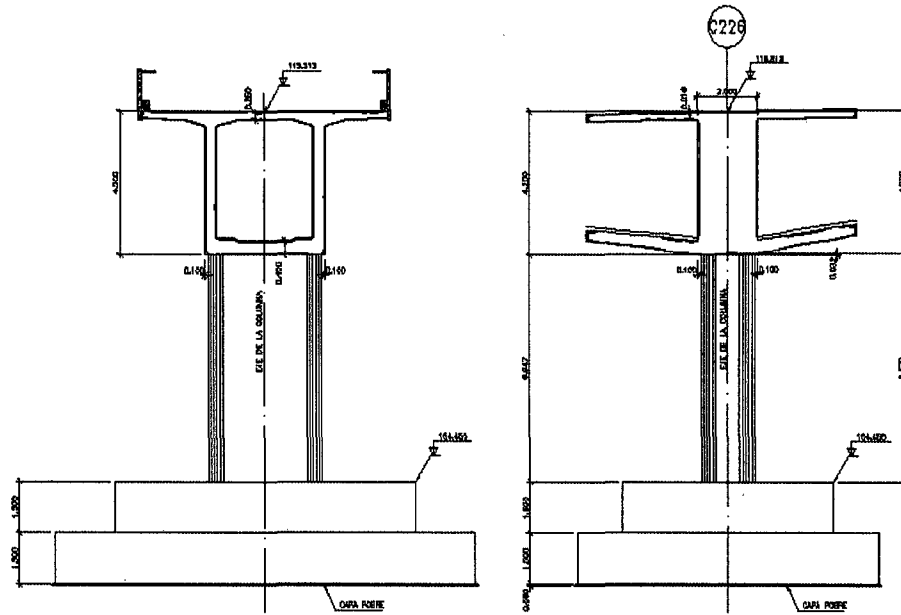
Elevación longitudinal y transversal de las columnas (C225 y C226)
